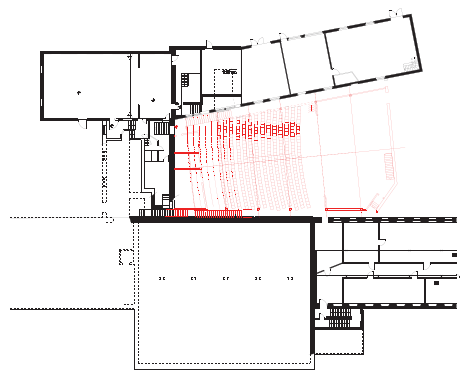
, Grundriss des Architekten mit Saalentwurf
